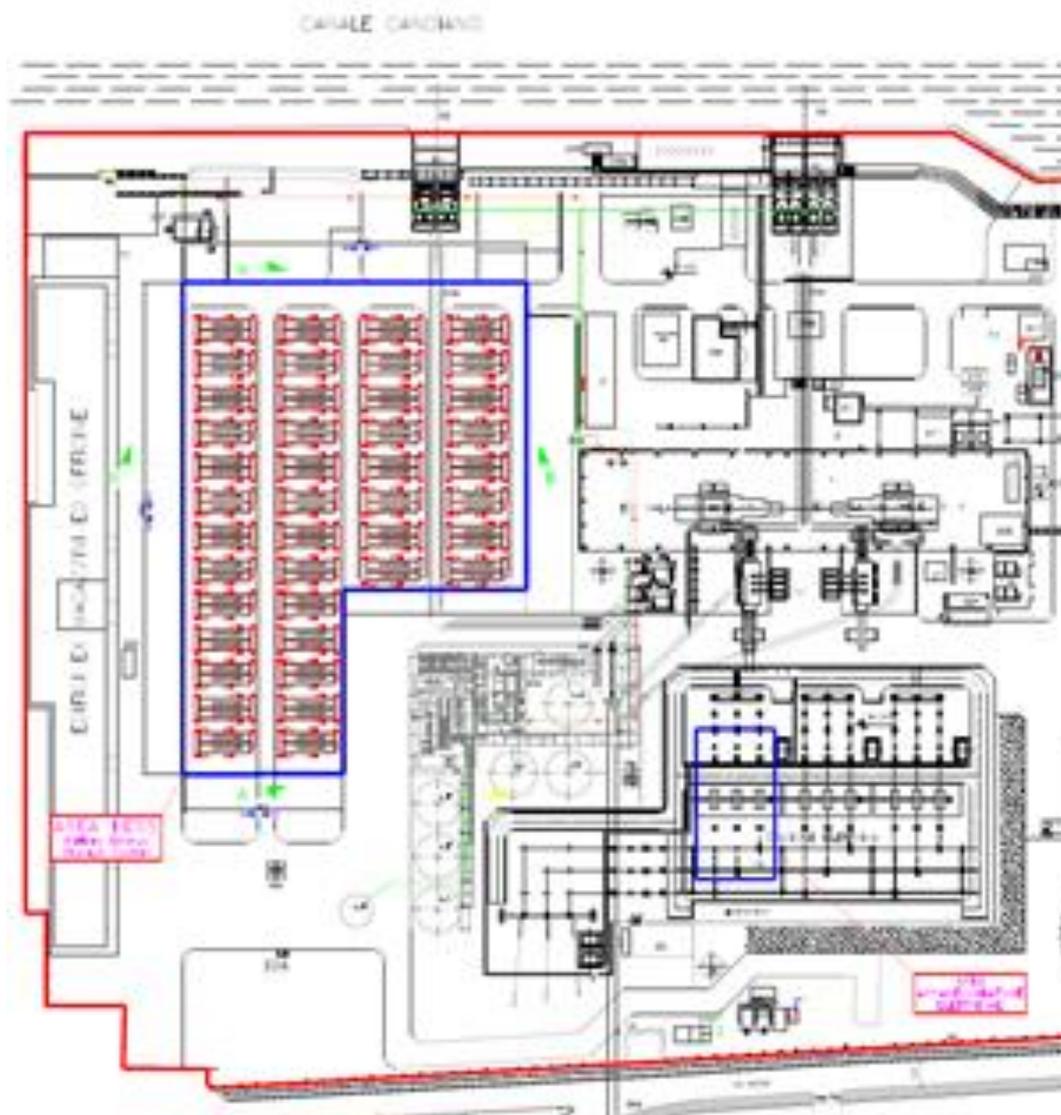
Planimetria generale dell’area di centrale interessata dalla realizzazione del BESS
